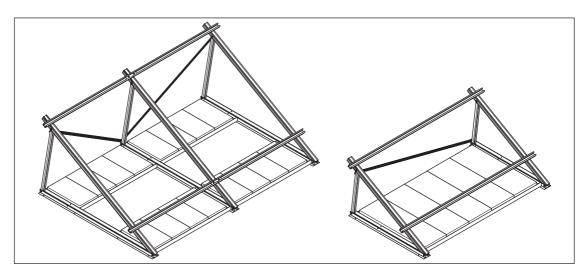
Fissare la struttura per tetto piano libera tramite pesi di zavorramento
